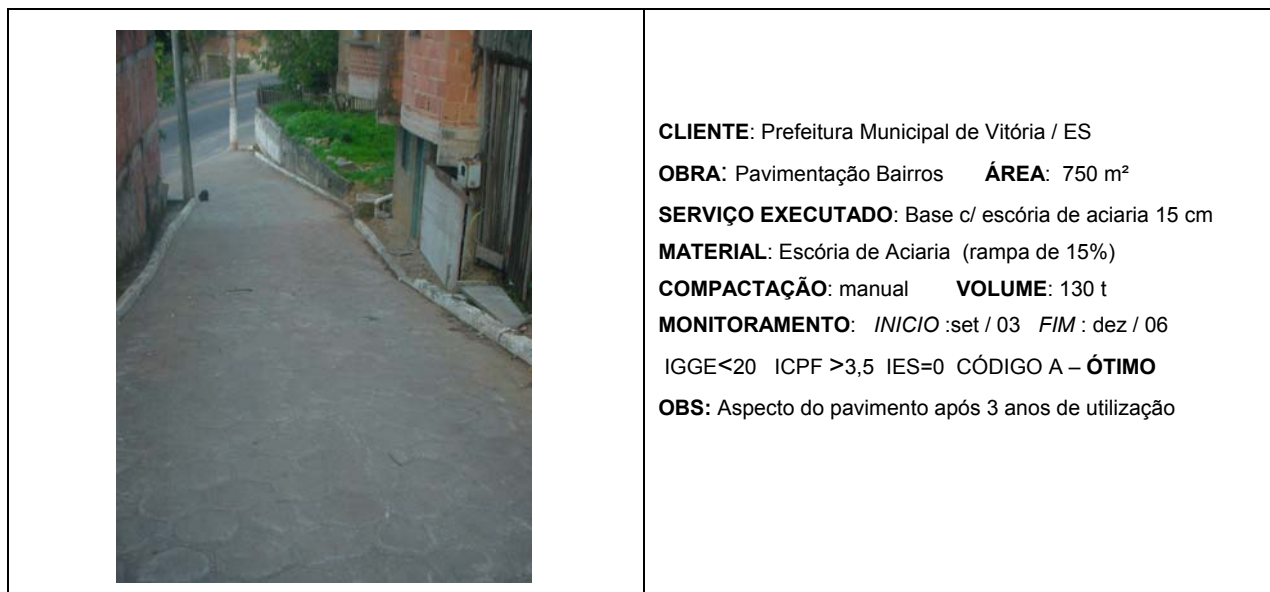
Levantamento visual contínuo da obra de pavimentação de bairros – Prefeitura Municipal de Vitória/ES
